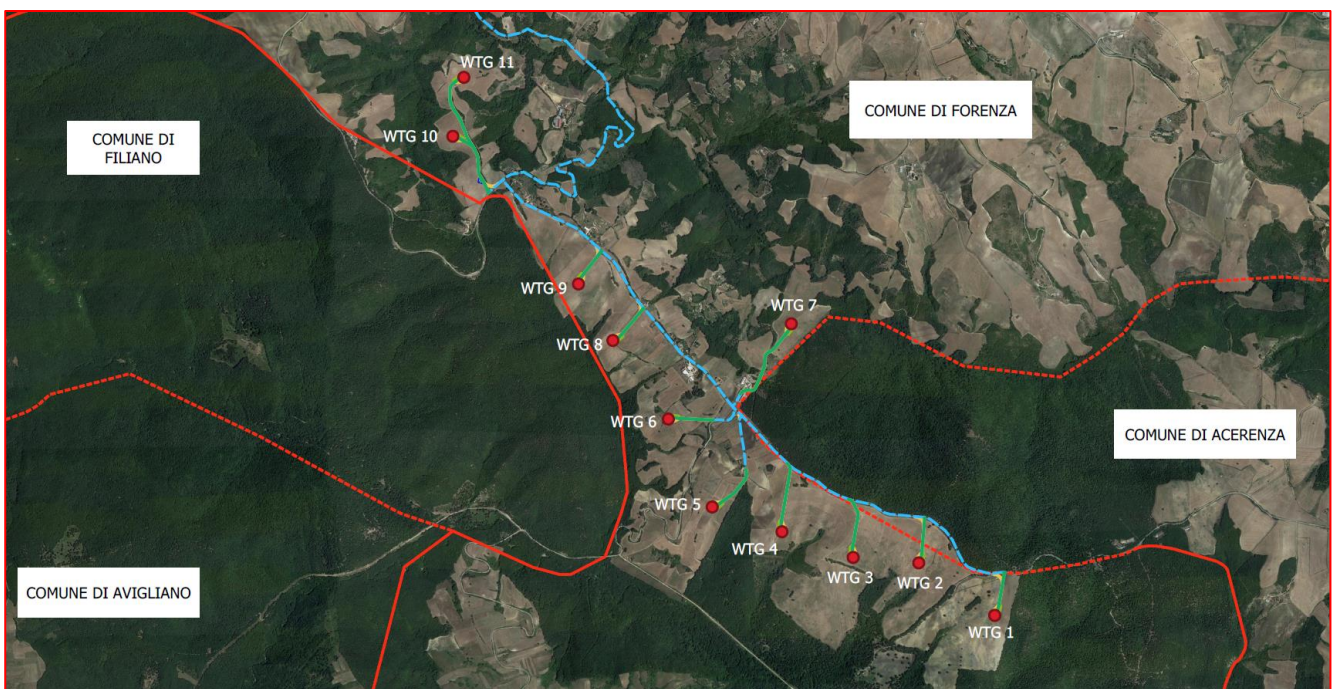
Area di intervento: dettaglio layout di progetto su ortofoto
